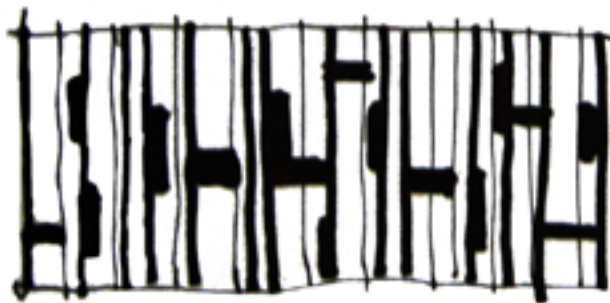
Modelo en plastilina para propuesta de pavimento
